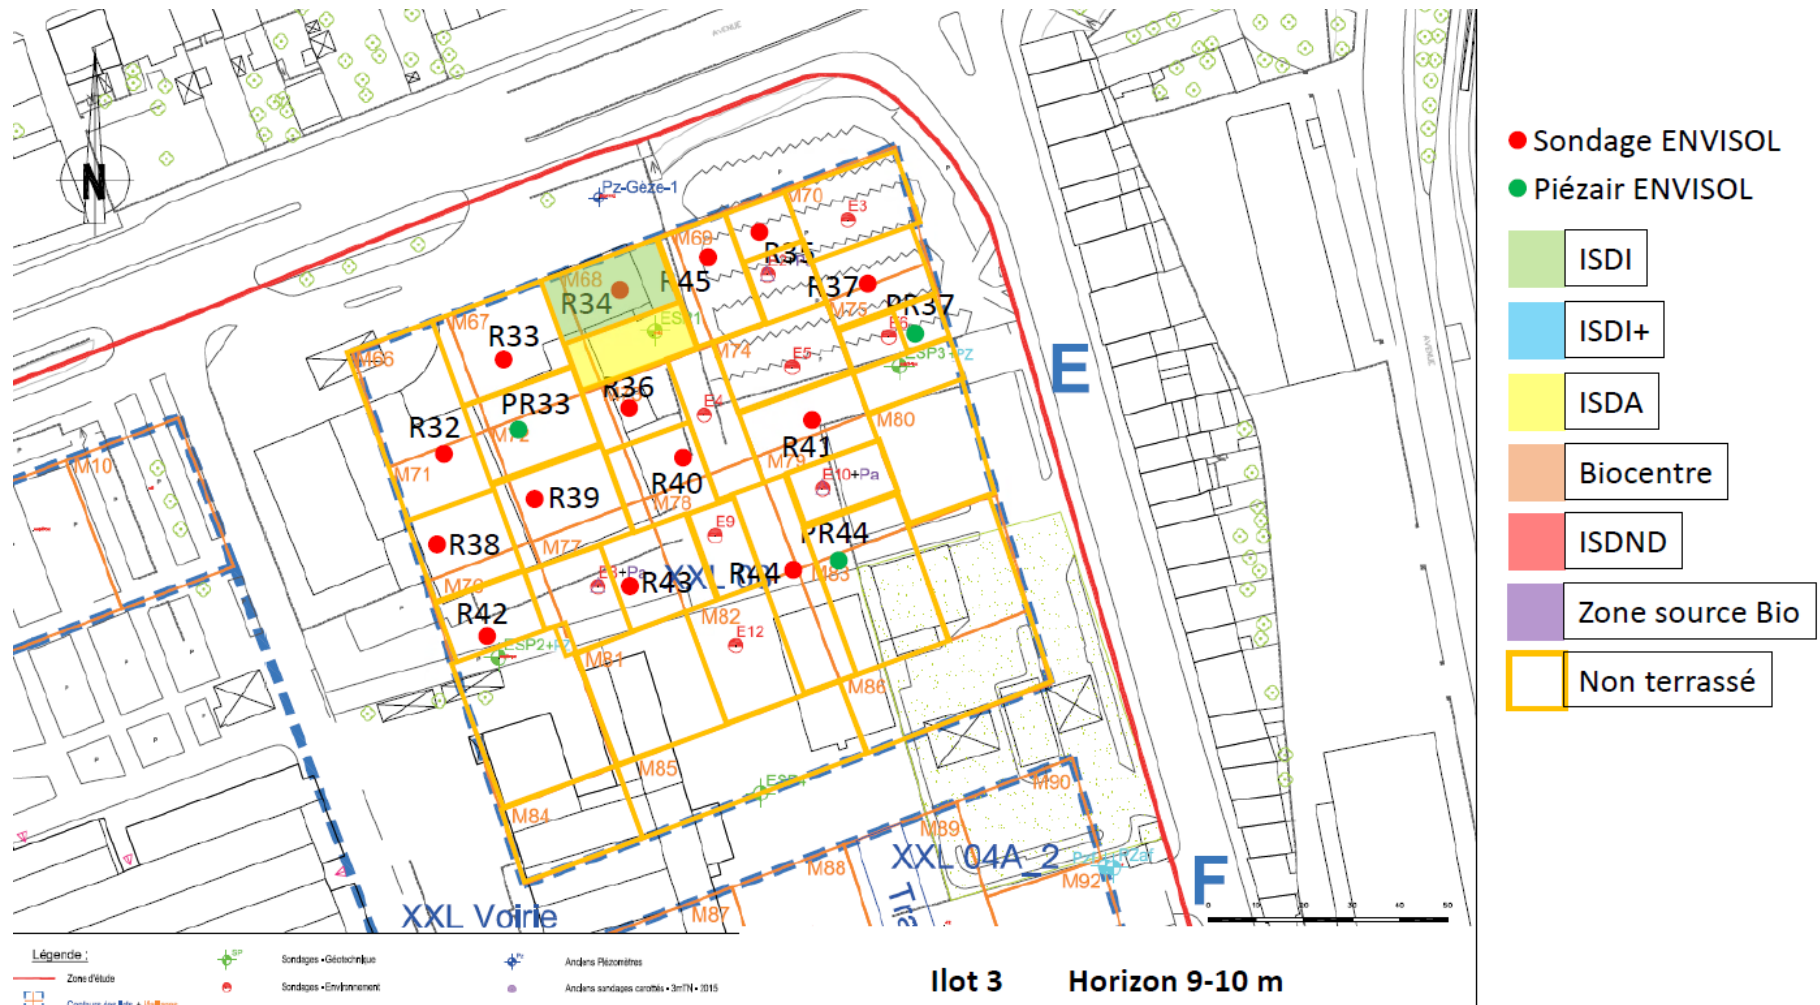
Plan de terrassement pour deux niveaux de sous-sol – Tranche de sol 9,0 – 10,0 m (Source : RESOLVE)
